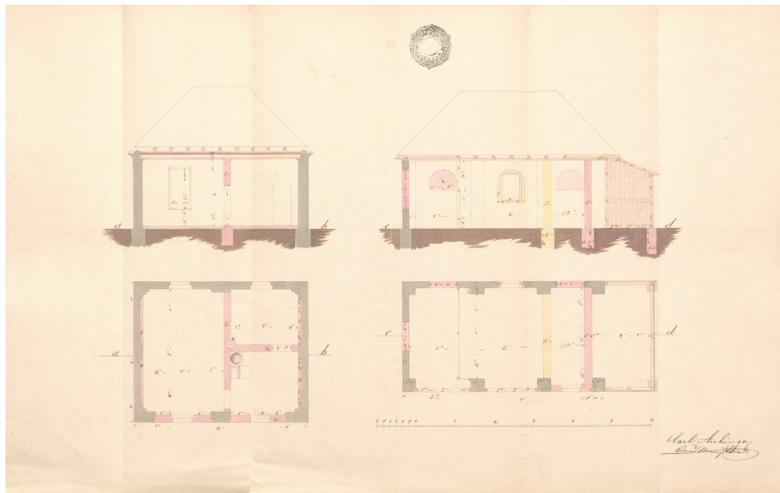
Umbauplan der Stallungen (Aichinger 1857)
